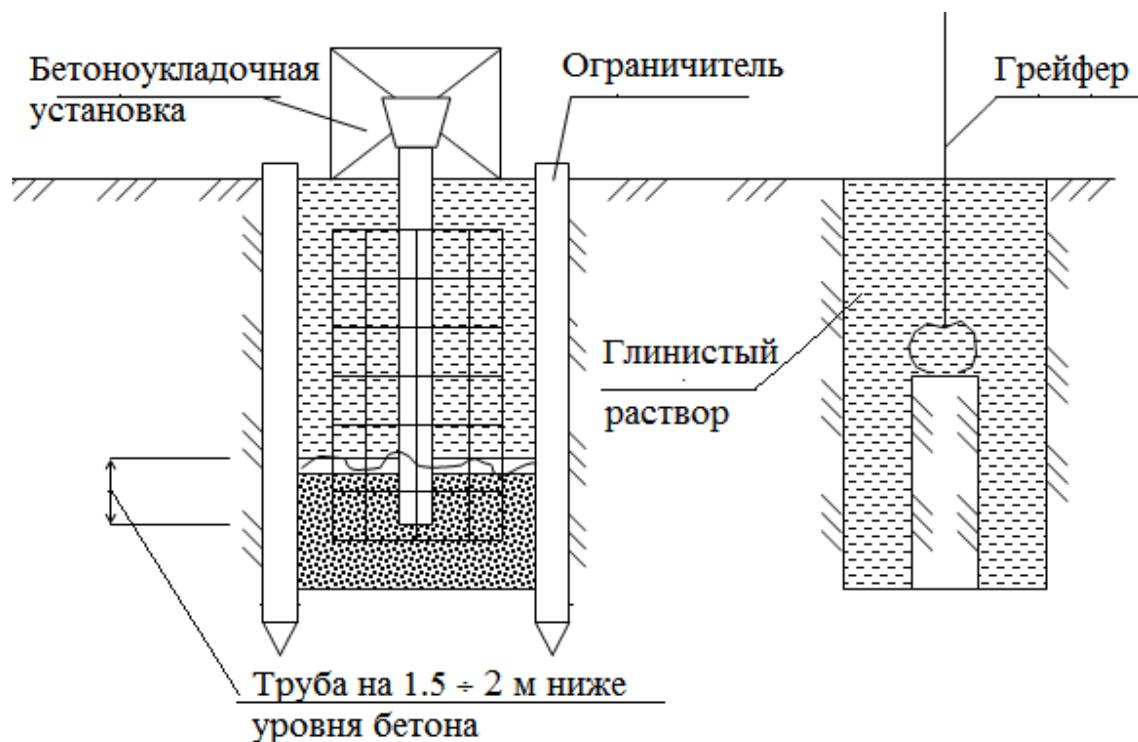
Схема монолитной «стены в грунте» разработкой траншеи через захватку
